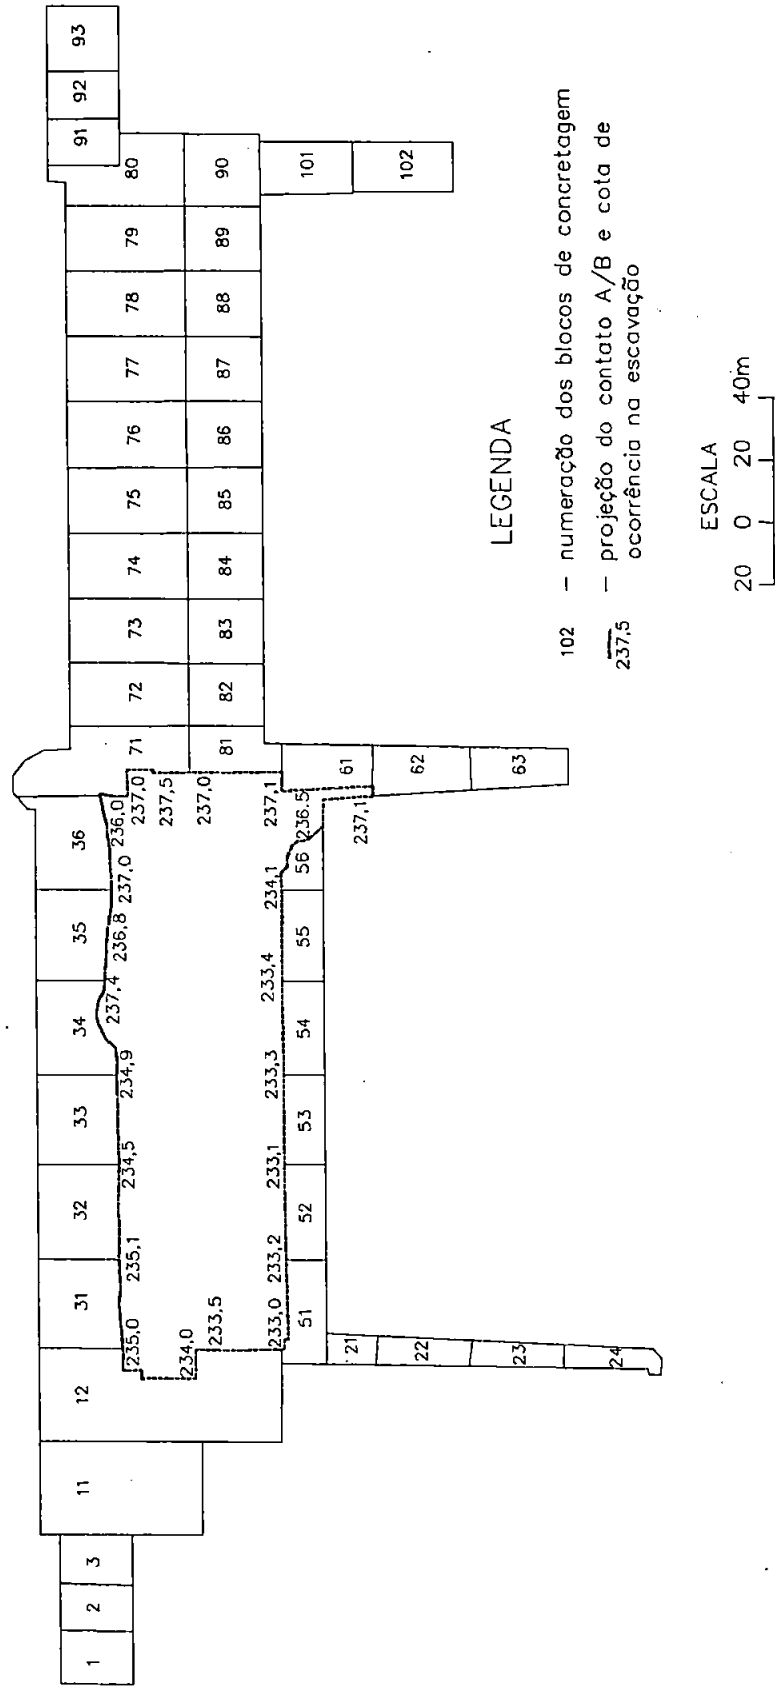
Planta da barragem e cotas de ocorrência do contato A/B na escavação.
